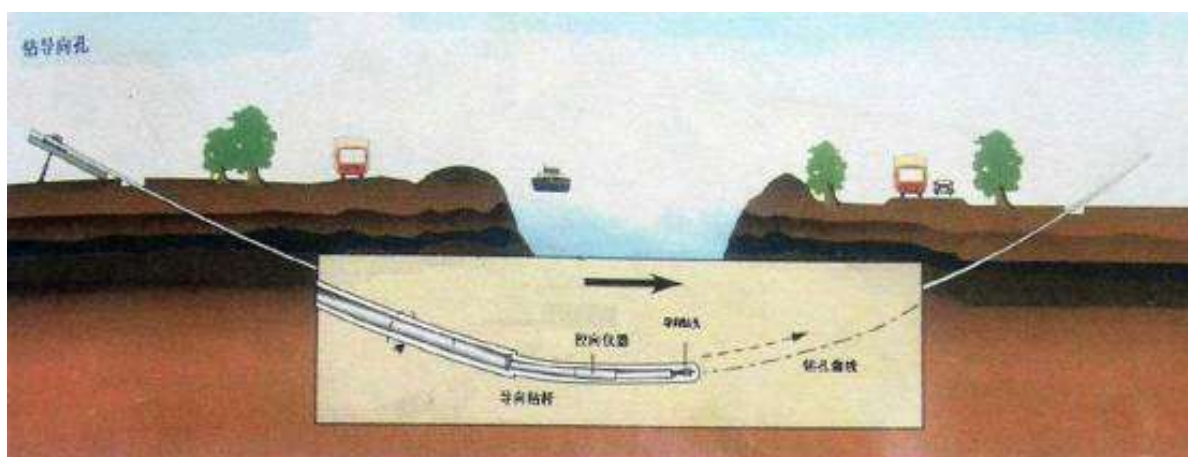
定向钻穿越施工钻导向孔过程断面示意图
